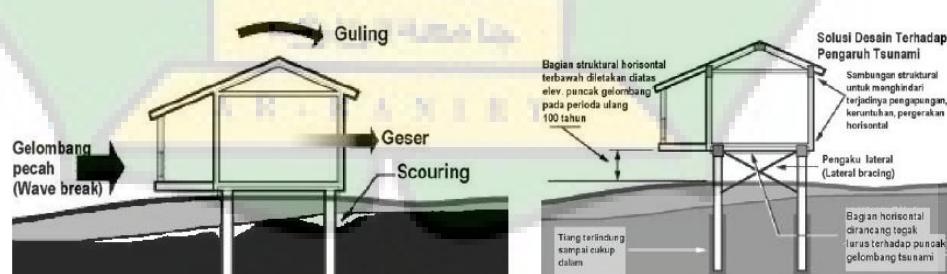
Skema Penataan kawasan pengurangan dampak tsunami pada reconstruction plan for Banda Aceh city
